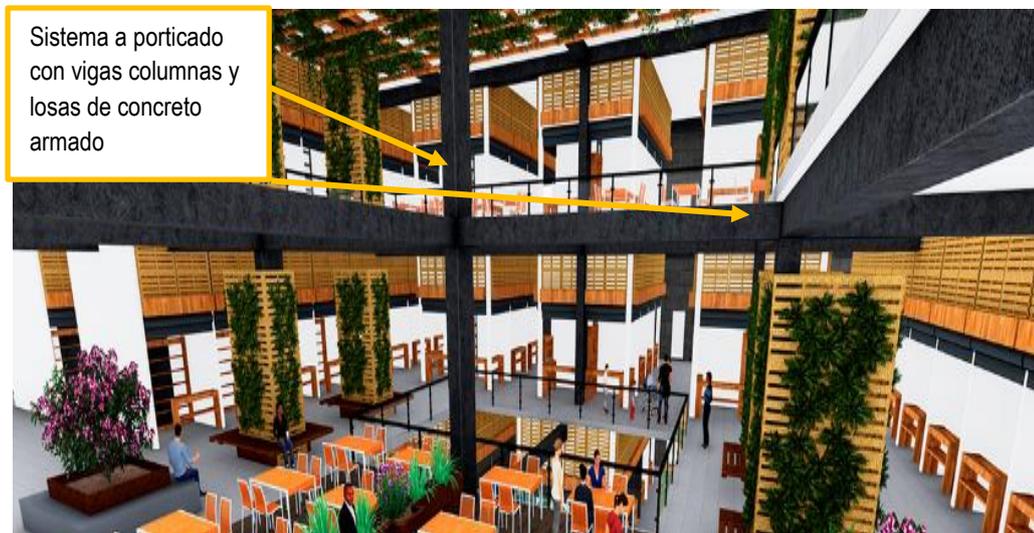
Detalle de columnas y vigas – sistema a porticado.
